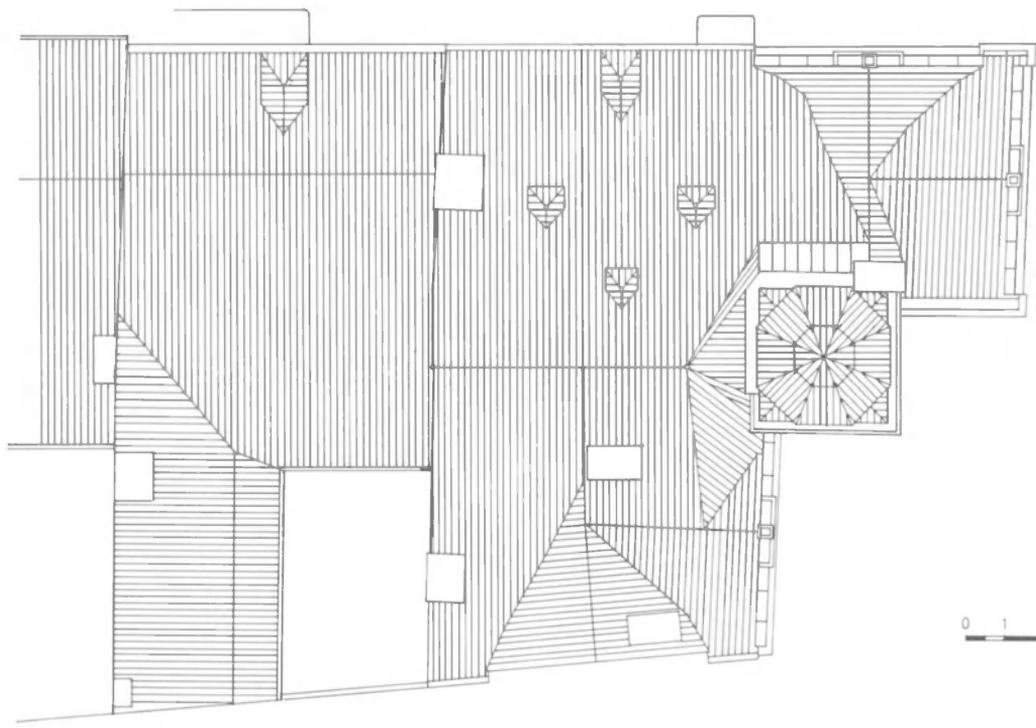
et 61. Plan du rez-de-chaussée et plan masse de la grande maison du Marché, état actuel. On notera la complexité des toitures, résultat de la présence de la tourelle d'escalier et des pignons. D'après F. Bonaert.
